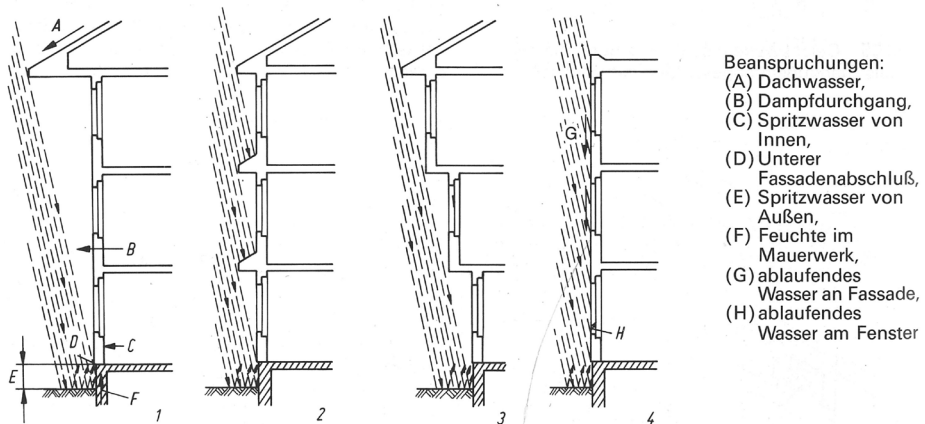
Beanspruchung von Gebäuden durch Feuchtigkeit. 1, 2, 3 geschützte Fassaden; 4 ungeschützte Fassade; Zeichnung entnommen aus [45 S. 244 Bild 58]
